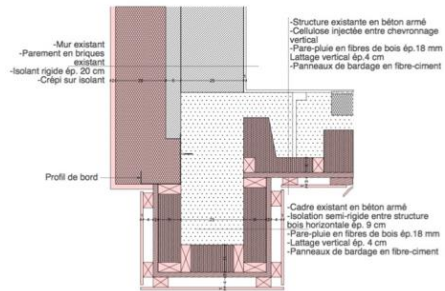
Détail en plan de l'isolation de la bande périphérique (AW Architectes, 2013)
